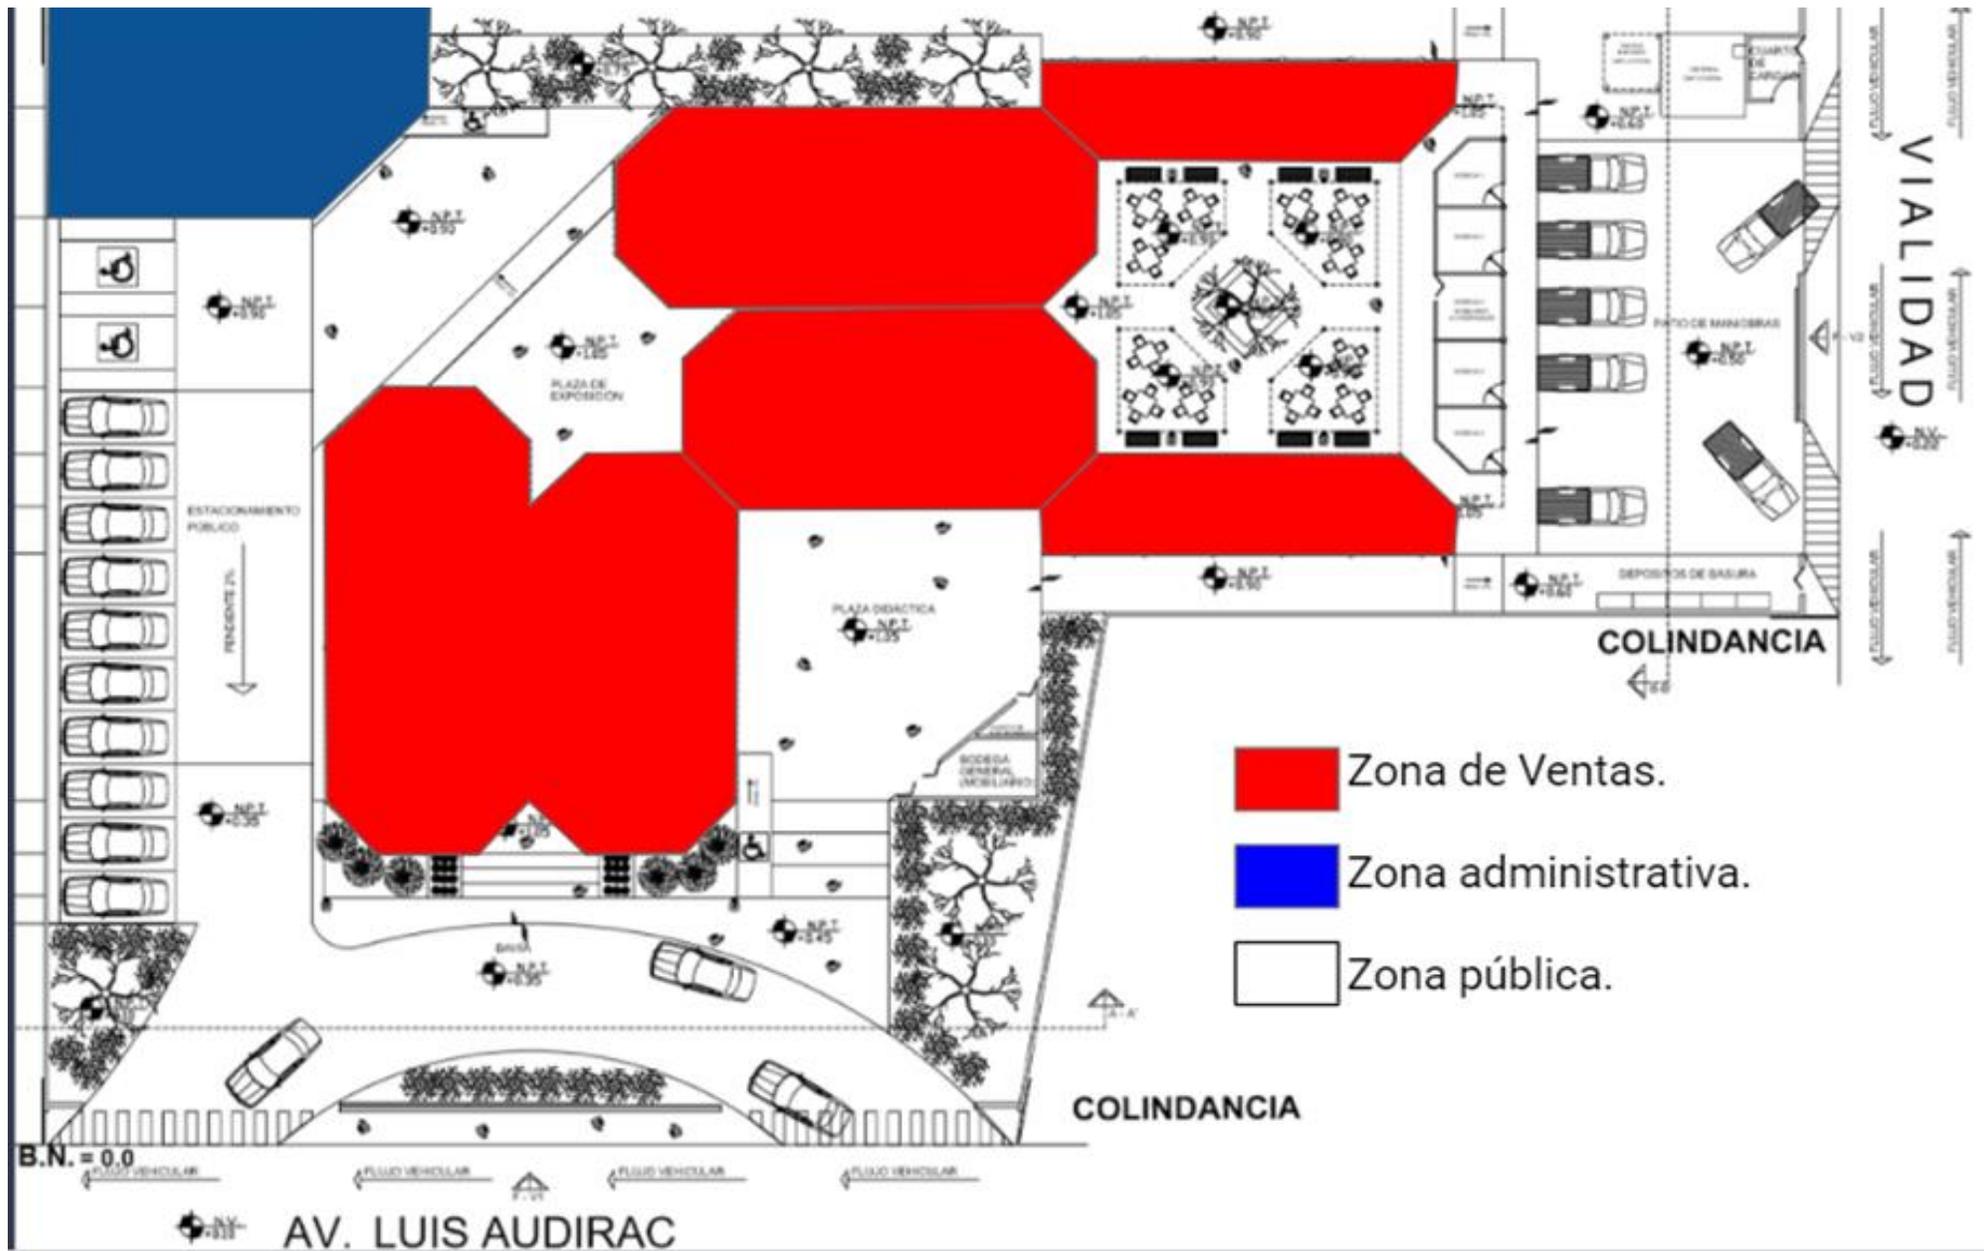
Fuente: Elaboración propia con base en la planta arquitectónica del proyecto propuesto (Áreas que componen el proyecto)
